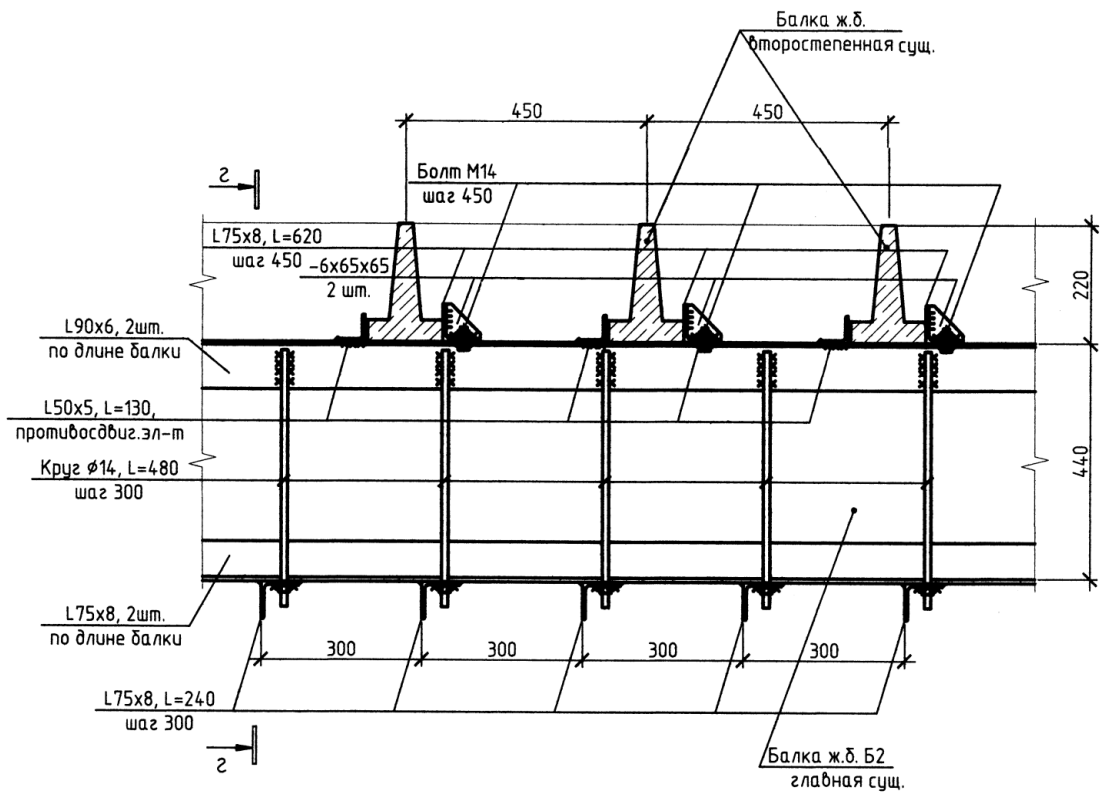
Усиленная балка перекрытий Б-2 в осях 13-17/Г-Ж согласно рабочей документации
